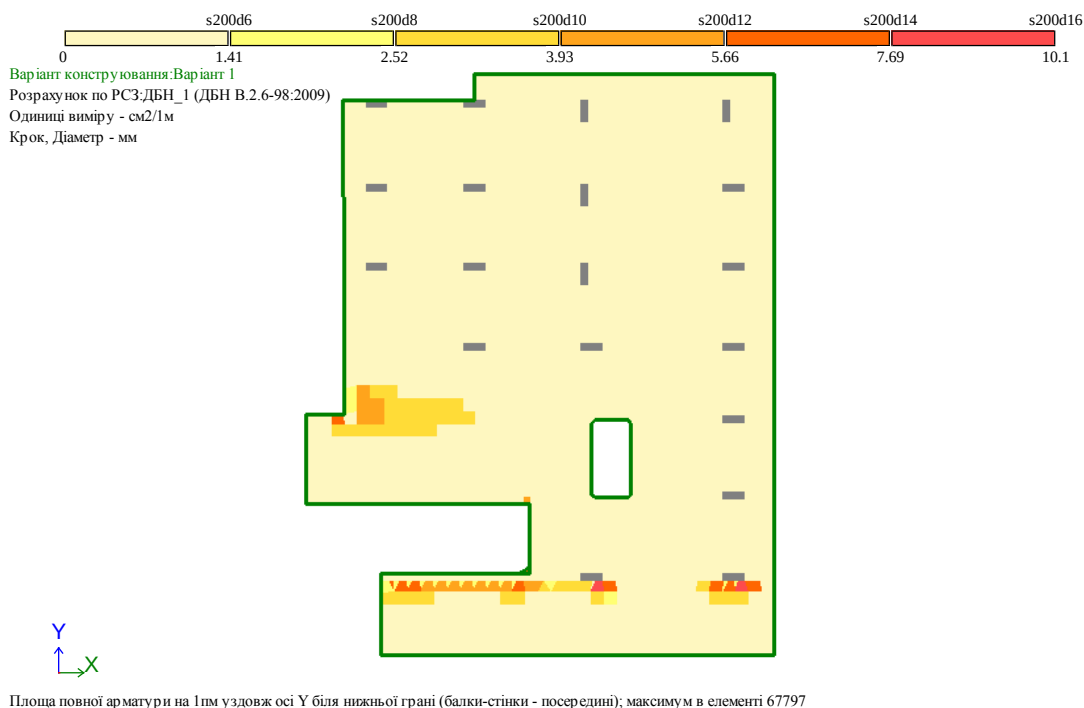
Армування плити перекриття типового поверху половини будівлі (нижня арматура в напрямку осі Y)
